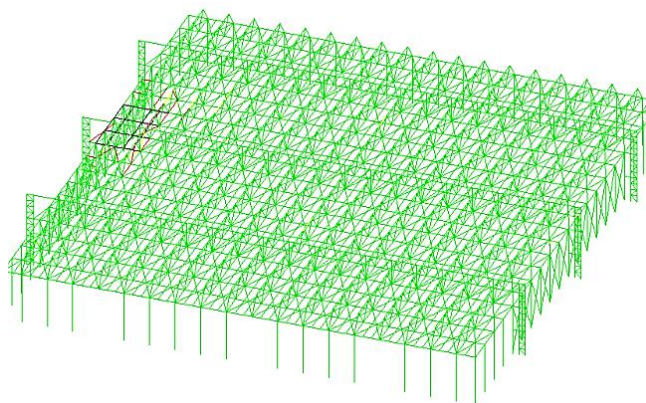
Критичний фактор для каркасу будівлі 1 у разі виходу з ладу прогонів і нижнього поясу ригеля рами
